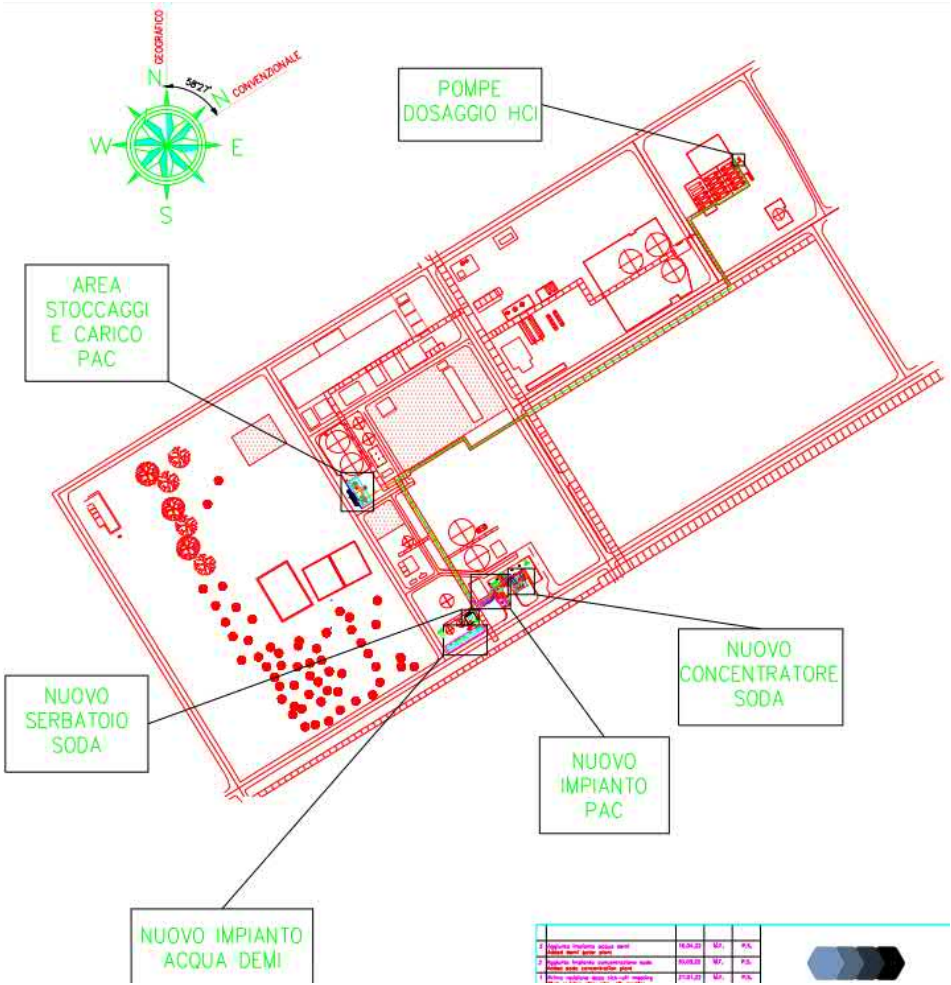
Localizzazione degli interventi in progetto nel layout generale dell'impianto
